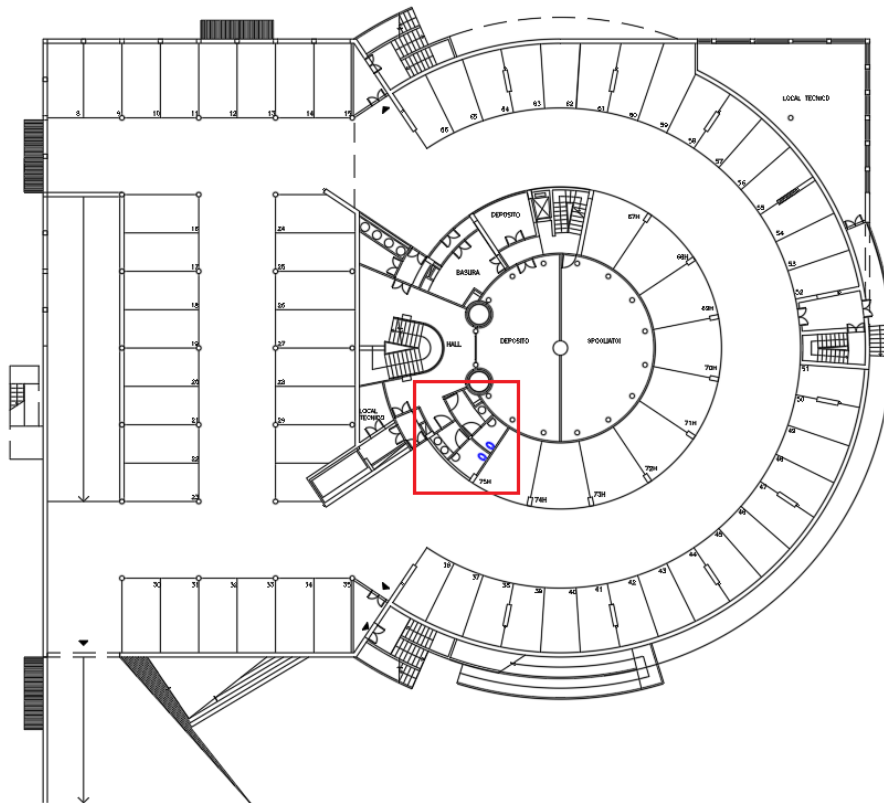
Ubicación de los locales húmedos en el primer sótano.
